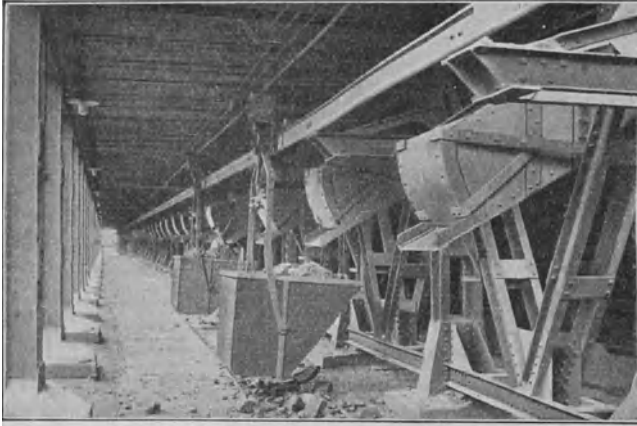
Beladetunnel unter den Erzfüllrumpfen in Neunkirchen (Bleichert).
